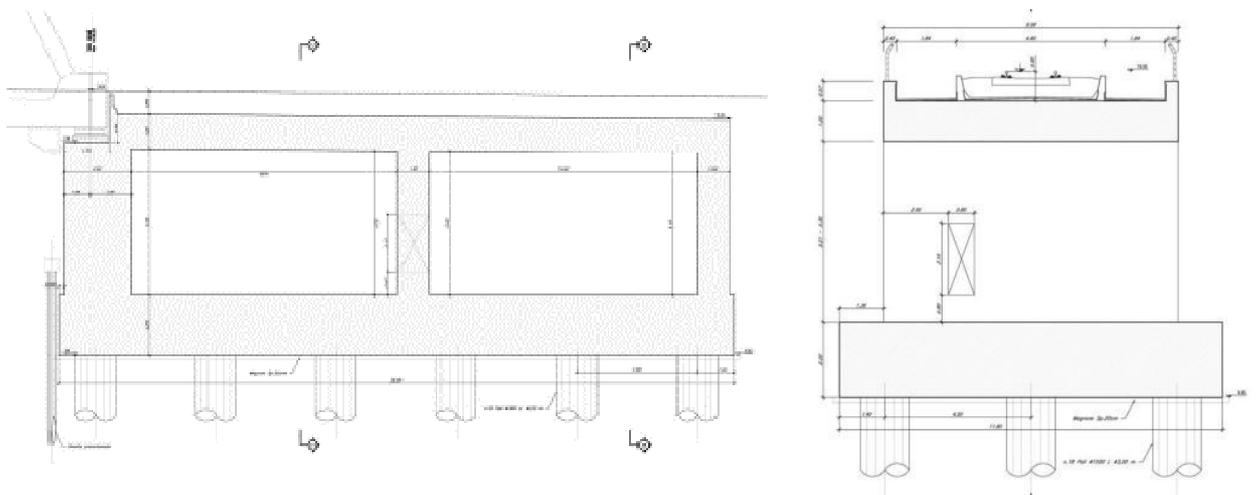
Sezione longitudinale e trasversale della spalla
